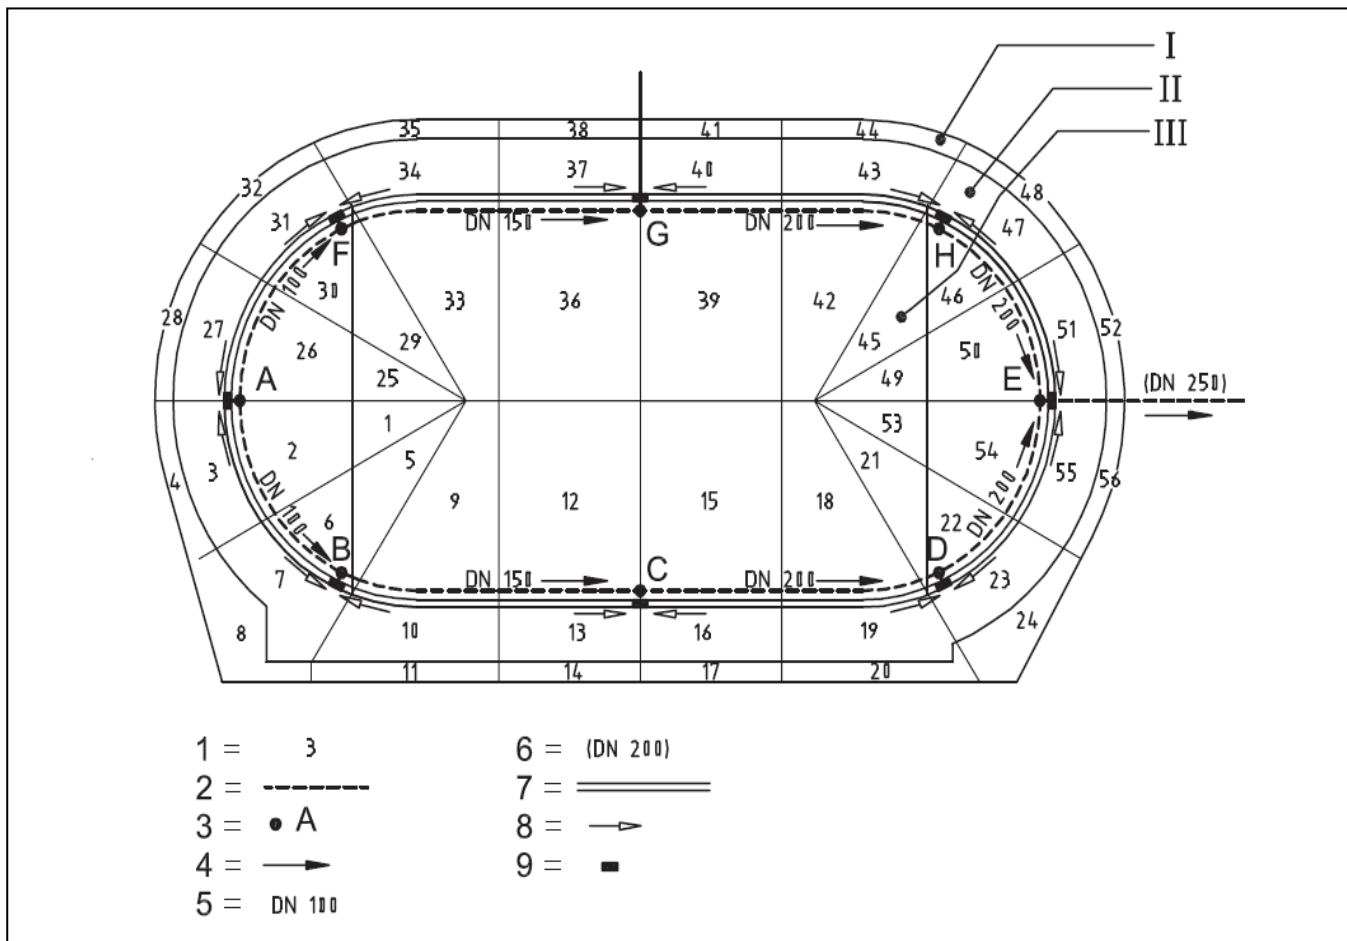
Exemple de calcul du drainage du terrain intérieur d'une installation d'entraînement et d'échauffement (voir aussi le tableau 3.3.5.2)
